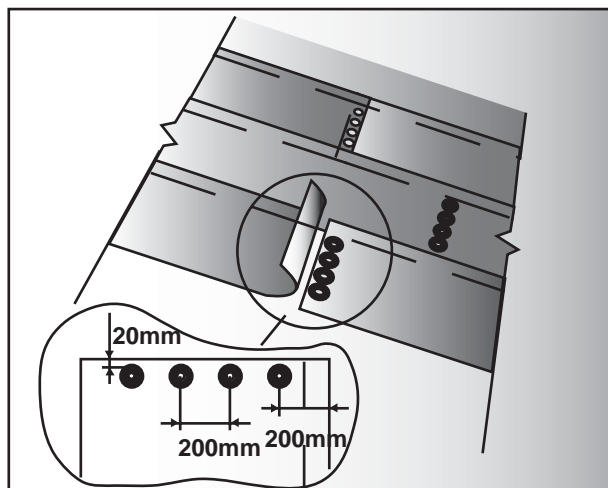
Механическое крепление материала нижнего слоя гидроизоляционного ковра к основанию.
